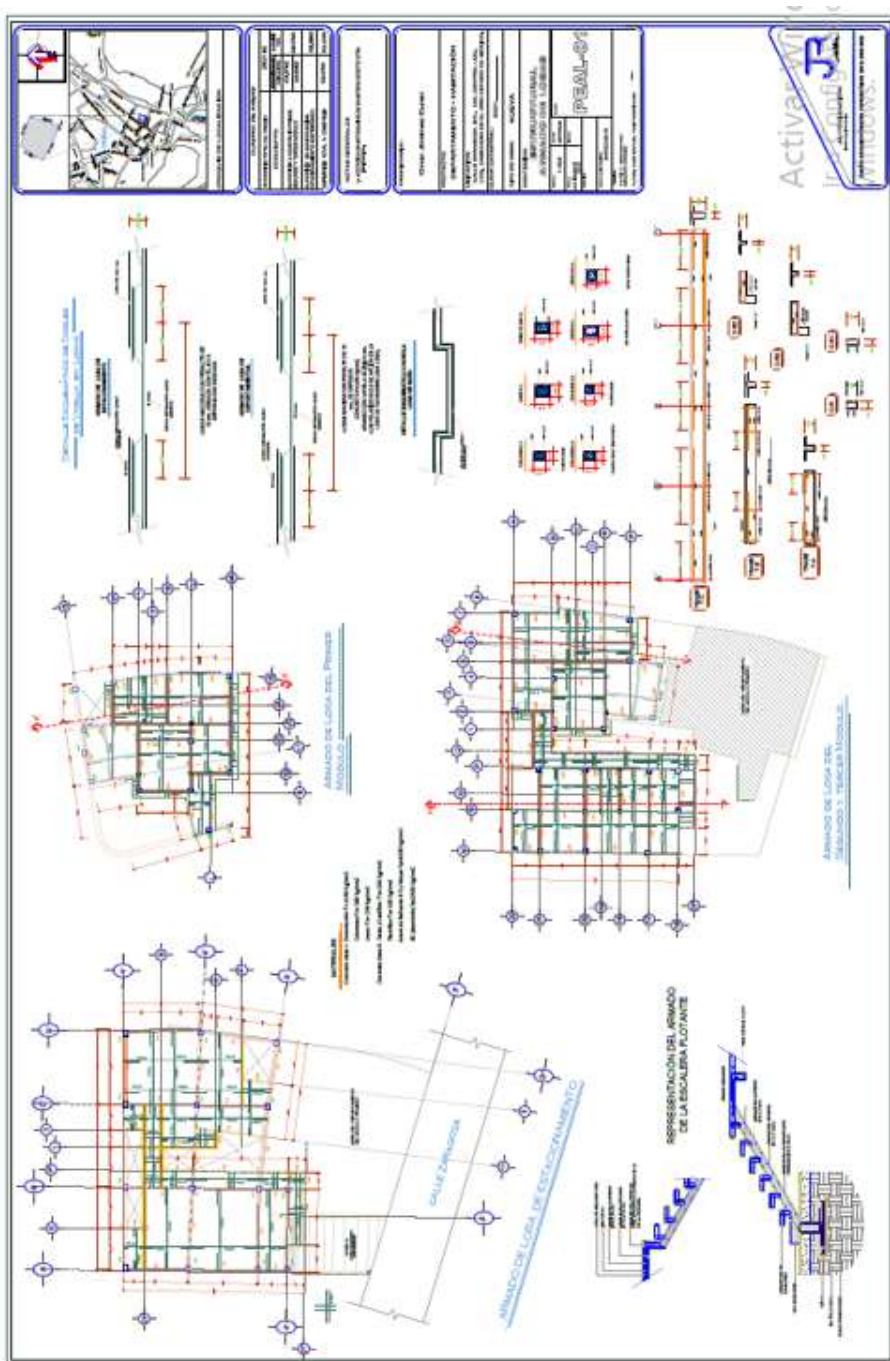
Imagen del plano de armado de losa, donde se especifica la propuesta de tipo de configuración de la estructura de las losas, donde queda interpretado la distancia de las bayonetas, las trabes de cerramiento, tanto en el estacionamiento subterránea, como en los tres módulos de departamentos, el detalle esquemático de la charola de la losa de baño, como las especificaciones de la resistencias de los materiales, sin dejar de mencionar la propuesta del armado de la escalera de servicio.
